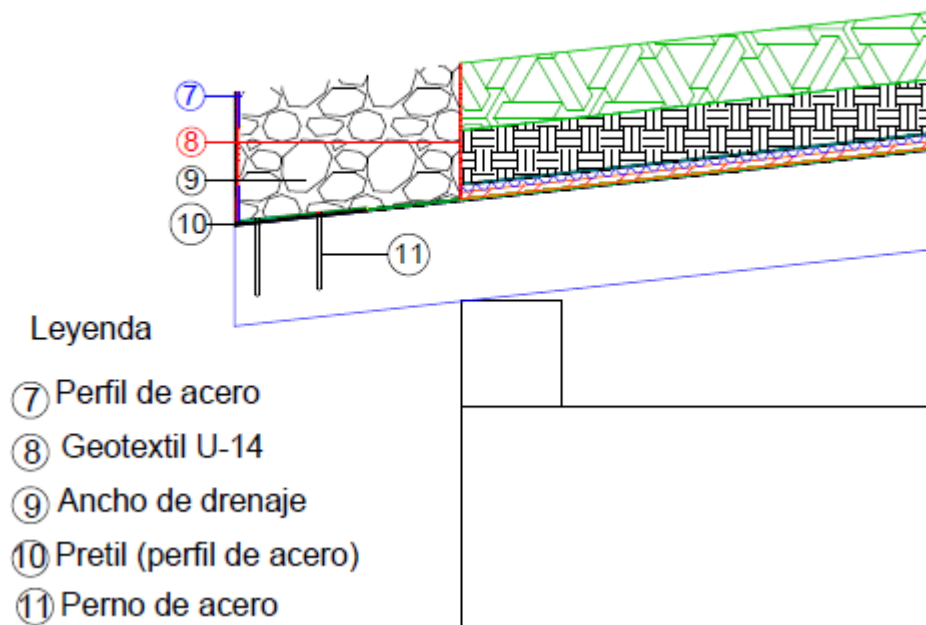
Detalle del pretil y del ancho de drenaje para la propuesta de la figura 44.
